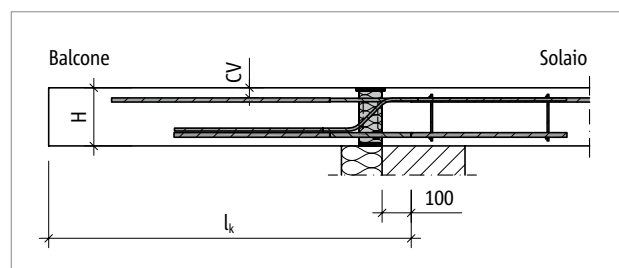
Schöck Isokorb® T tipo KP-M13 – M14: sistema statico
